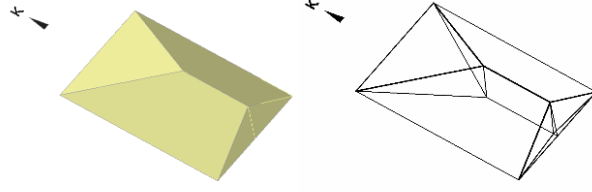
Hacim oluşturulması (Canan, 2008, s:64)
